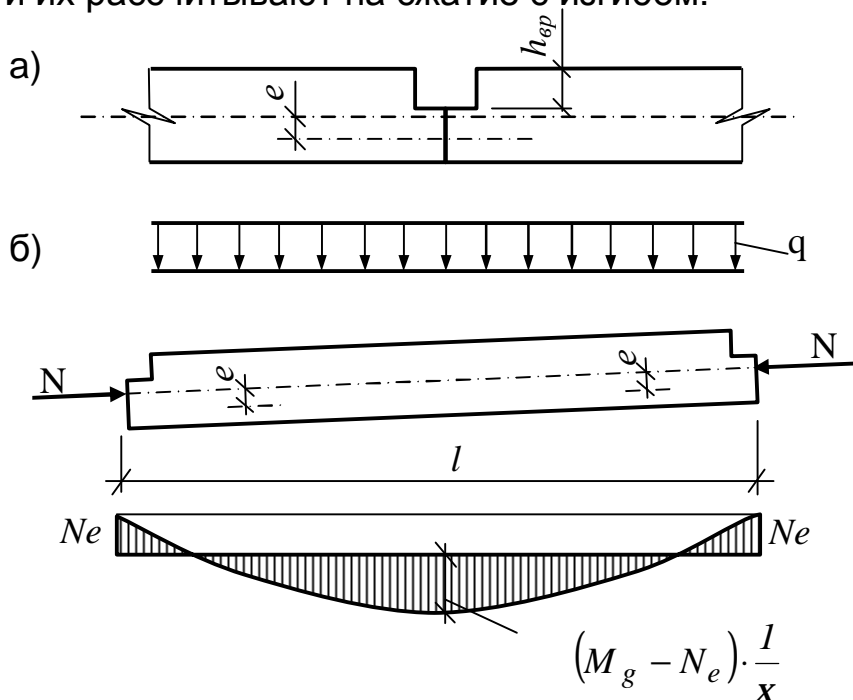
Внецентренное стыкование в узлах (а) и расчётная схема верхнего пояса (б)
